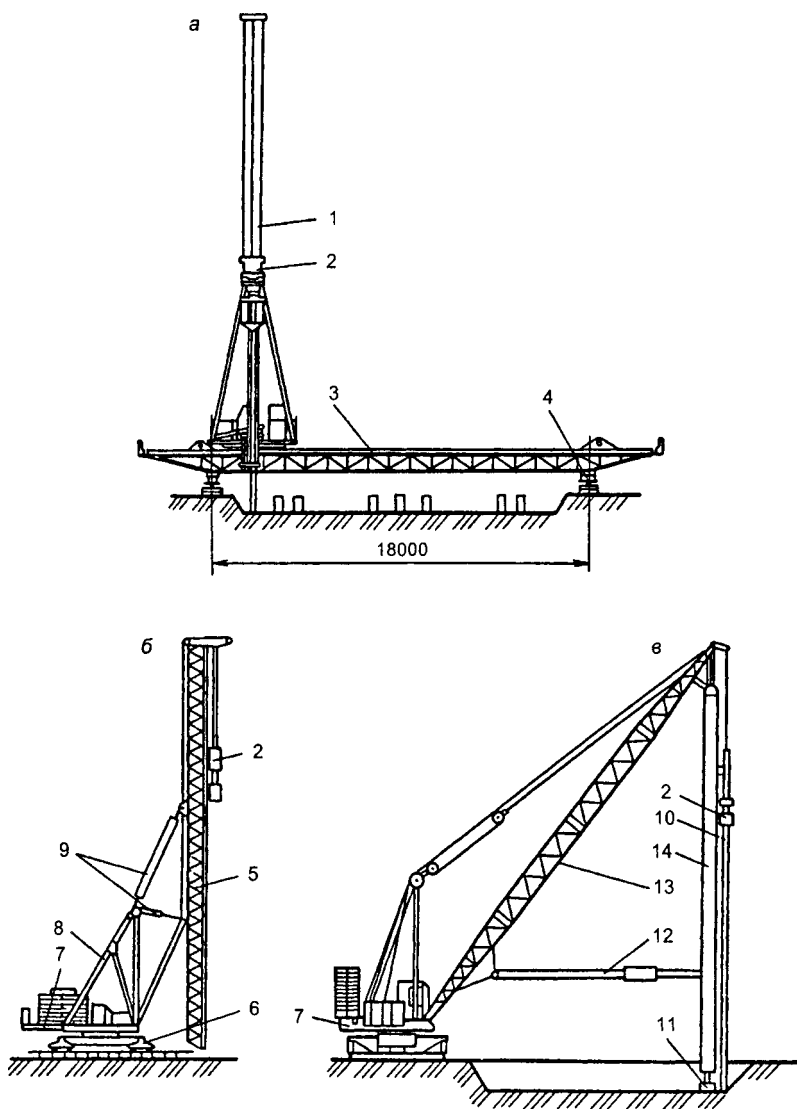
Схемы свайных установок на рельсовом ходу:
